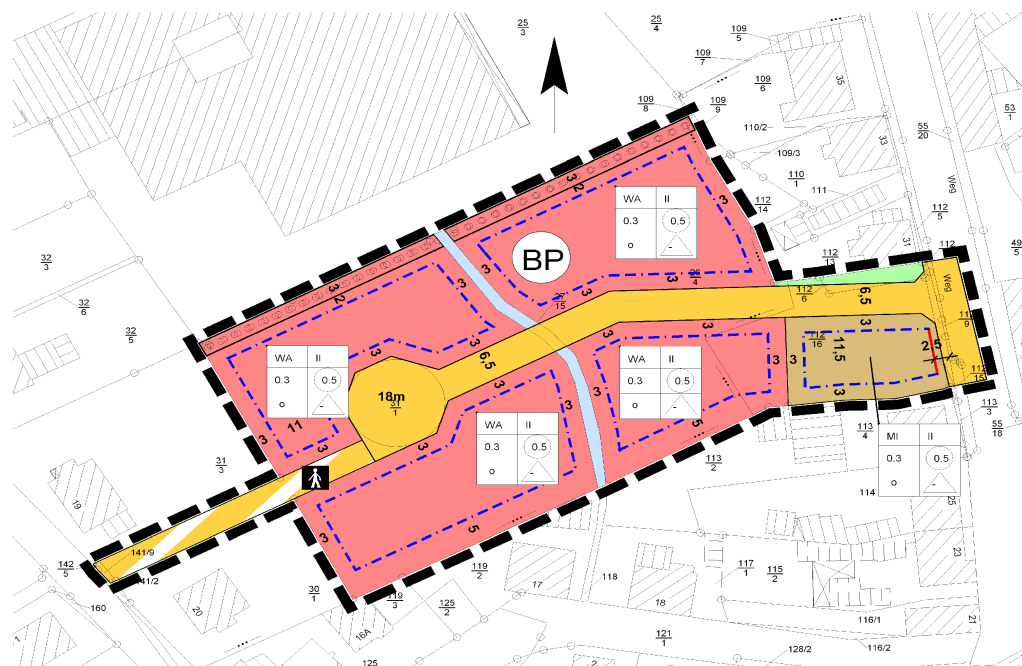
5. Änderung des Bebauungsplans „Vor dem Scharenberg“
